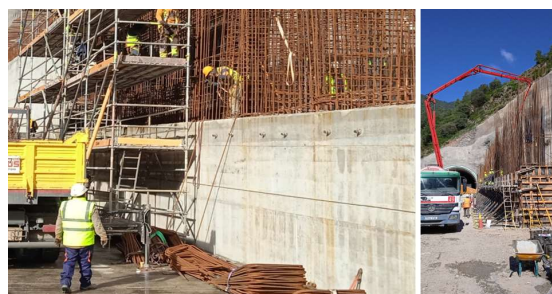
Encofrado y hormigonado de zona 1 fase 1 de hastial izquierdo.
